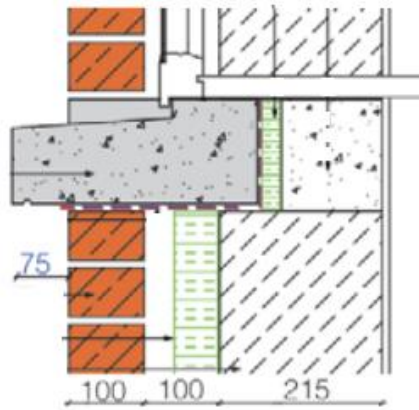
Corte de zona de vão, com destaque para formato do peitoril
